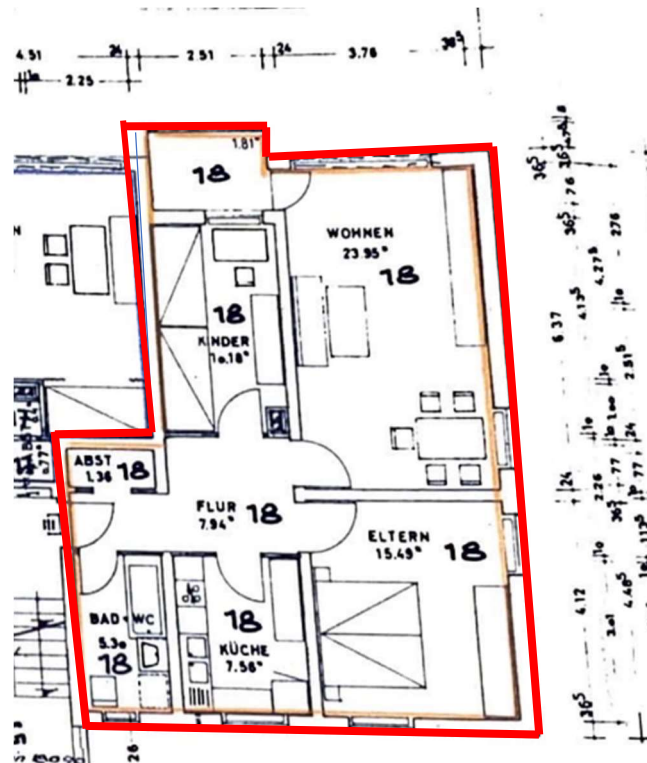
Grundriss Wohnung Nr. 18
